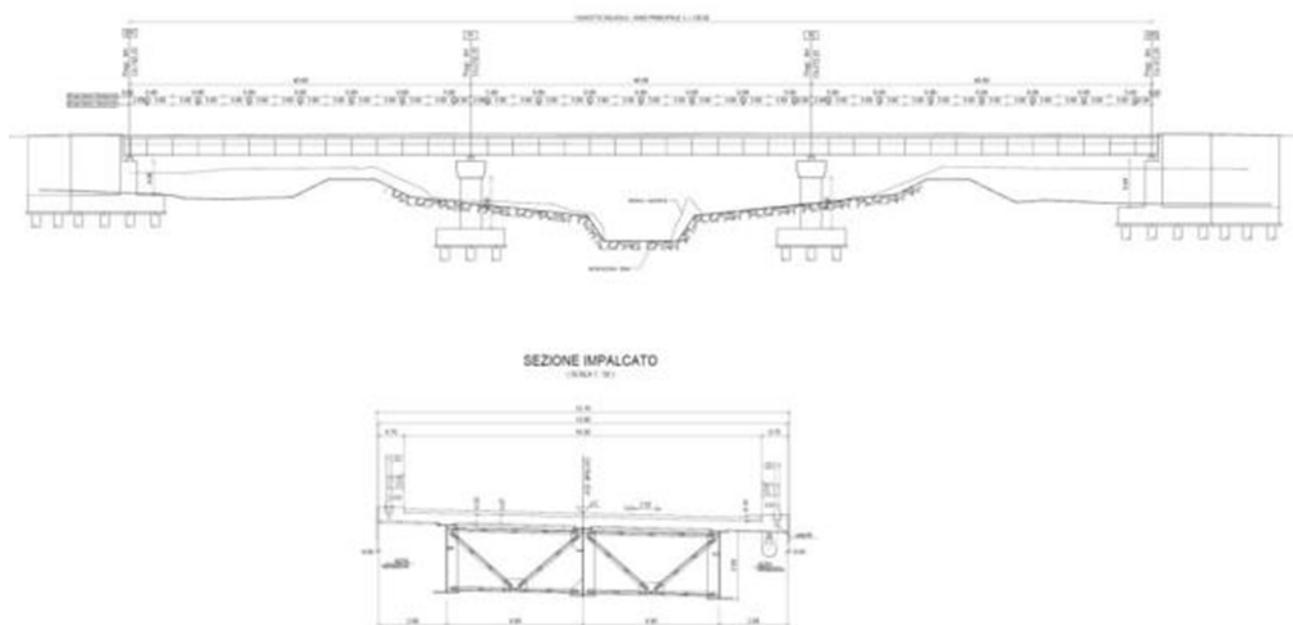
Sezioni di Progetto Viadotto Torrente Salsola
